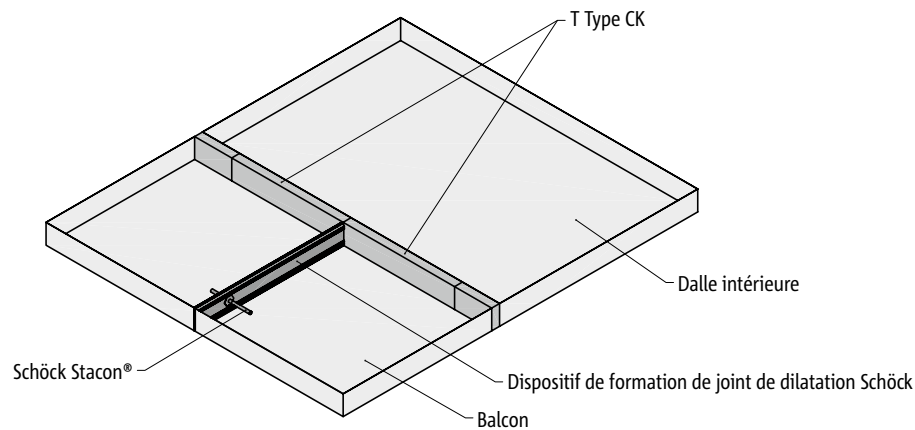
Schöck Isokorb® Type CK : le dispositif de formation de joint de dilatation
